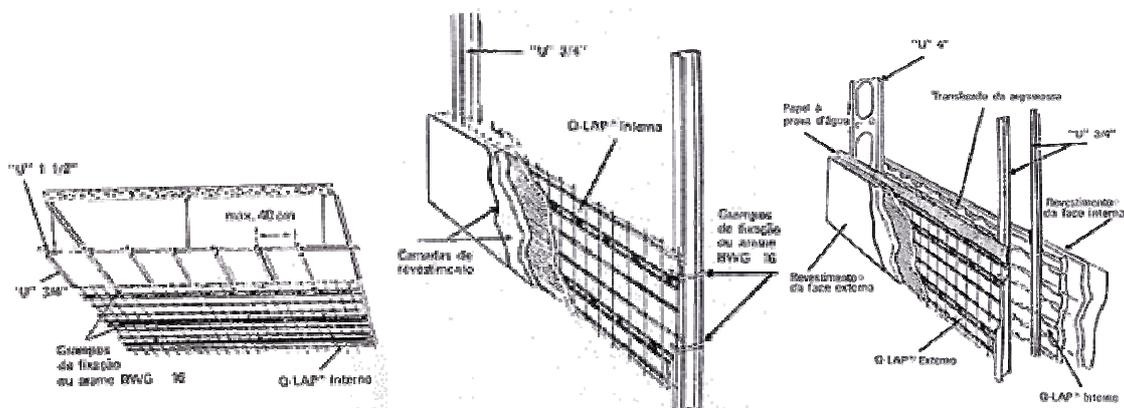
Lajes, paredes simples e paredes duplas de telas Q-Lap
